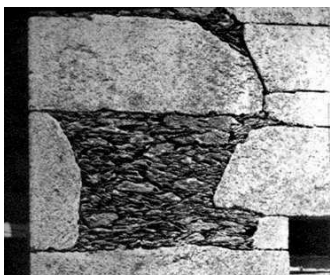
Detalle de la fachada de granito y pizarra de la vivienda anterior
